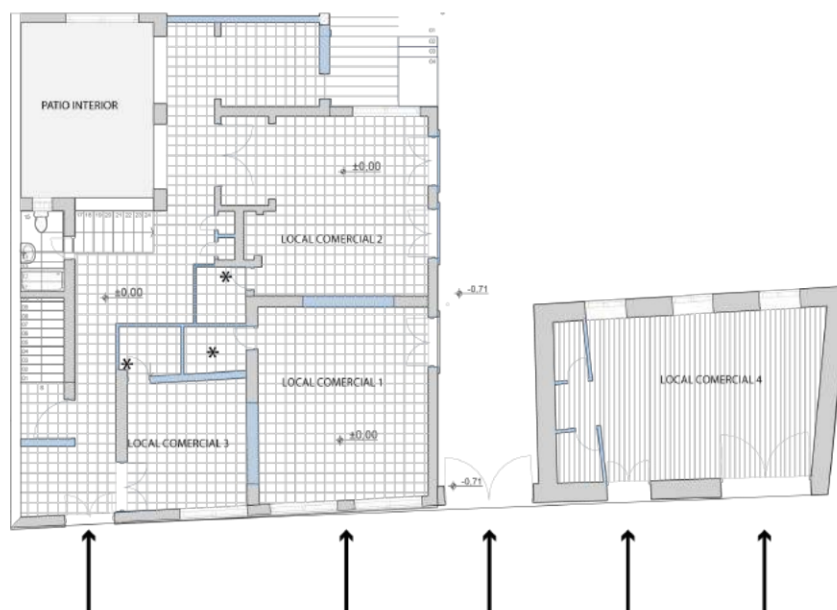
Acceso principal al conjunto residencial casa Cordero // Fuente: (Surrealestudio, 2021).
